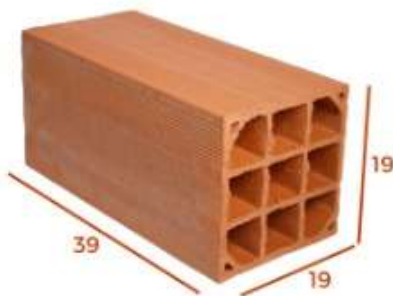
Bloco cerâmico 19x19x39cm utilizado em toda a construção da alvenaria
